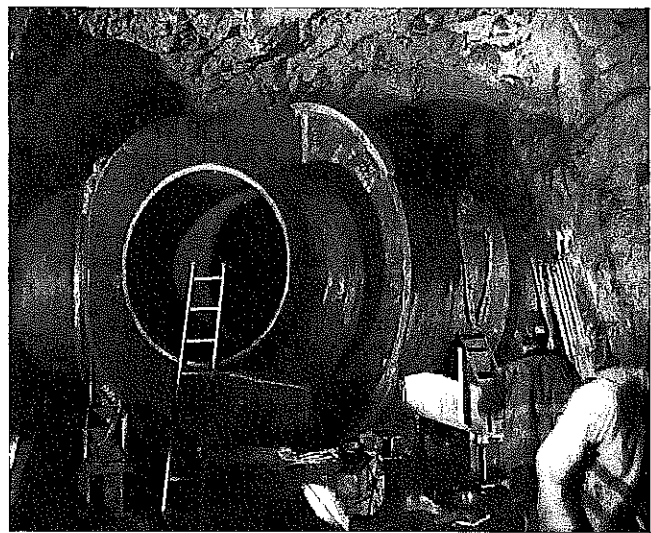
Hosenrohr für das Wasserkraftwerk Tierfehd-Limmern (Schweiz) mit Sichelblech S690QL+Z35 in 210 mm Dicke.
